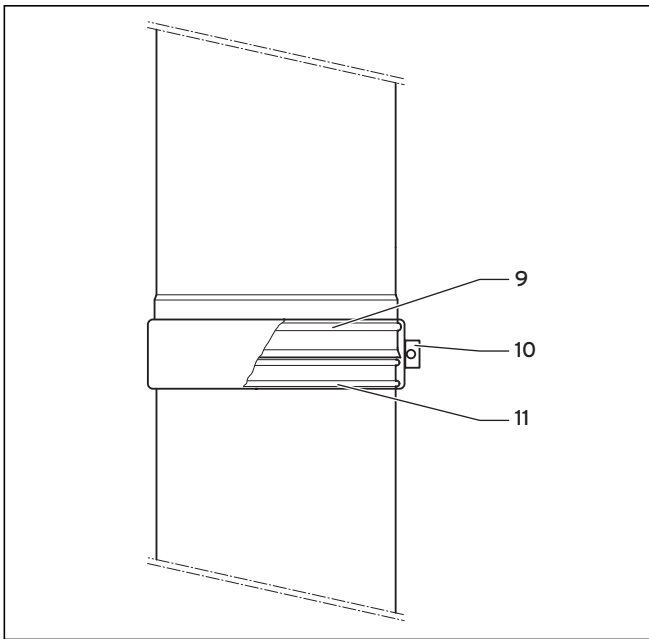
Крепление элементов наружной стены с помощью хомута воздуховода
